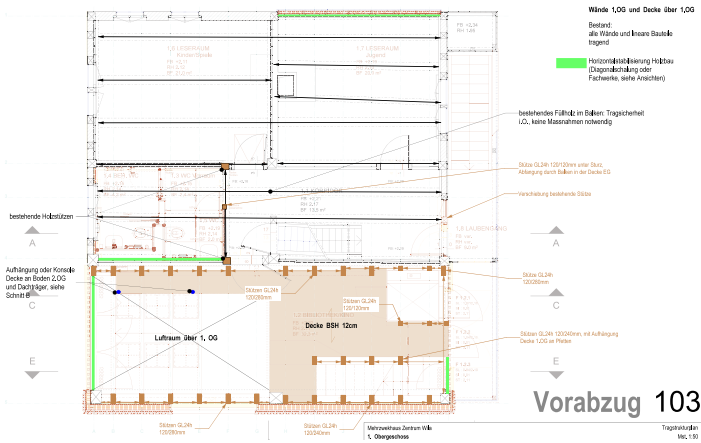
Grundriss 1. OG Bauingenieur Konzept
